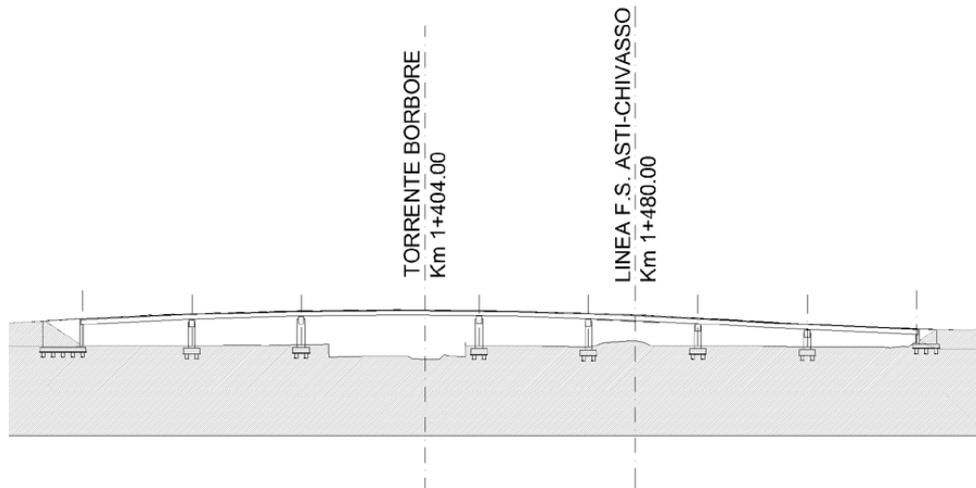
F Viadotto F.S. Asti – Alba – Prospetto
